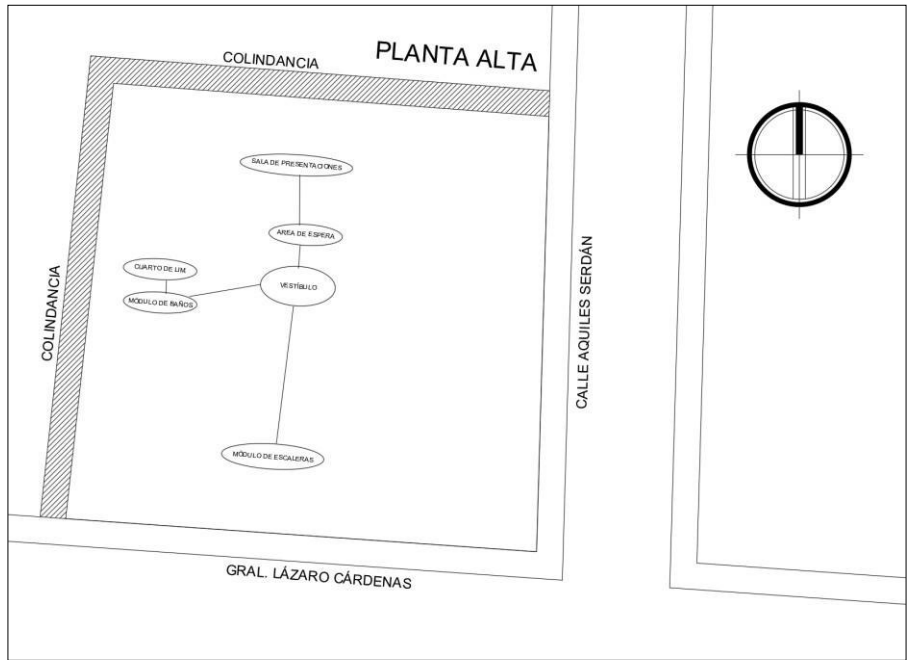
Primera Propuesta, Planta Alta. Propia 2021.
